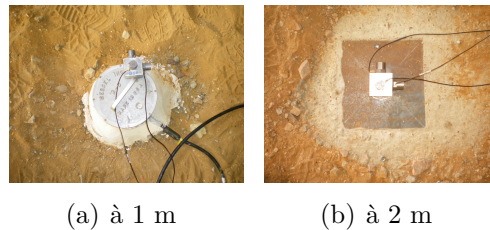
Instrumentation en dehors de la planche 2 à une distance connue du pied du remblai
